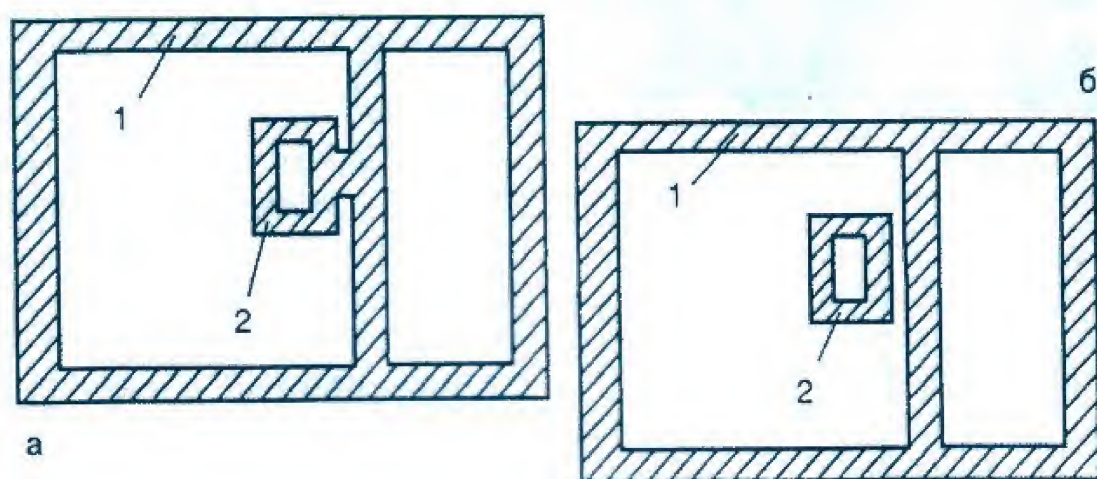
Улаштування фундаменту під грубку: а – неправильно; б – правильно; 1 – стрічковий фундамент; 2 – фундамент під грубку
